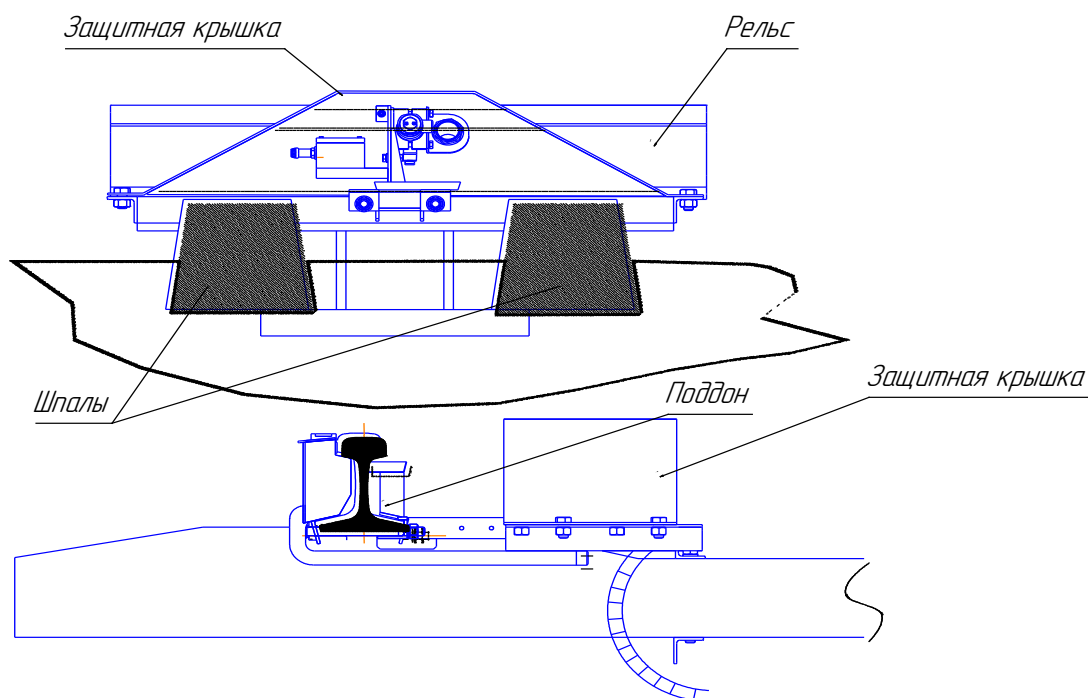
Поддон и защитная крышка устройства смазки
